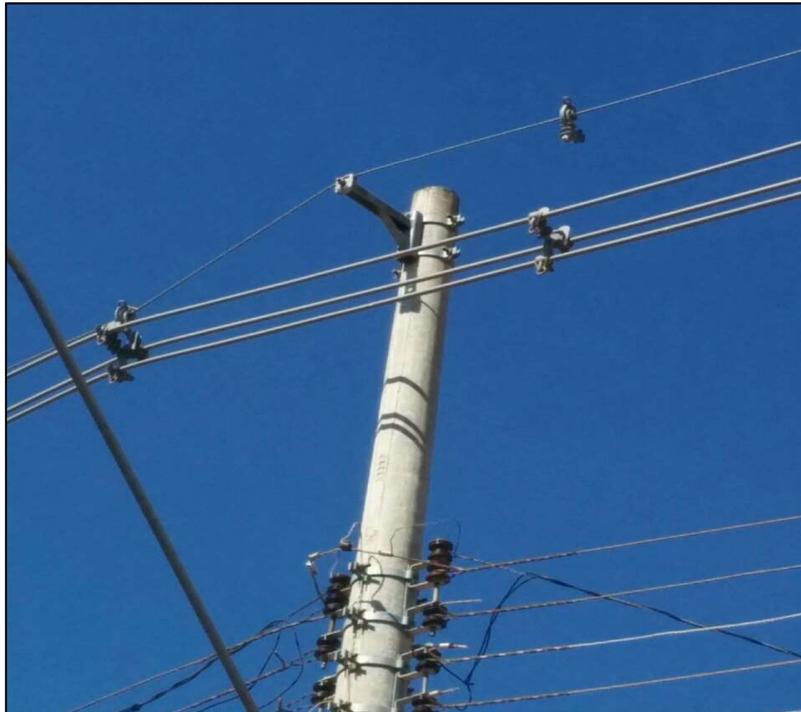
Espaçador losangular quebrado em rede compacta. Fonte: Acervo do Autor.
